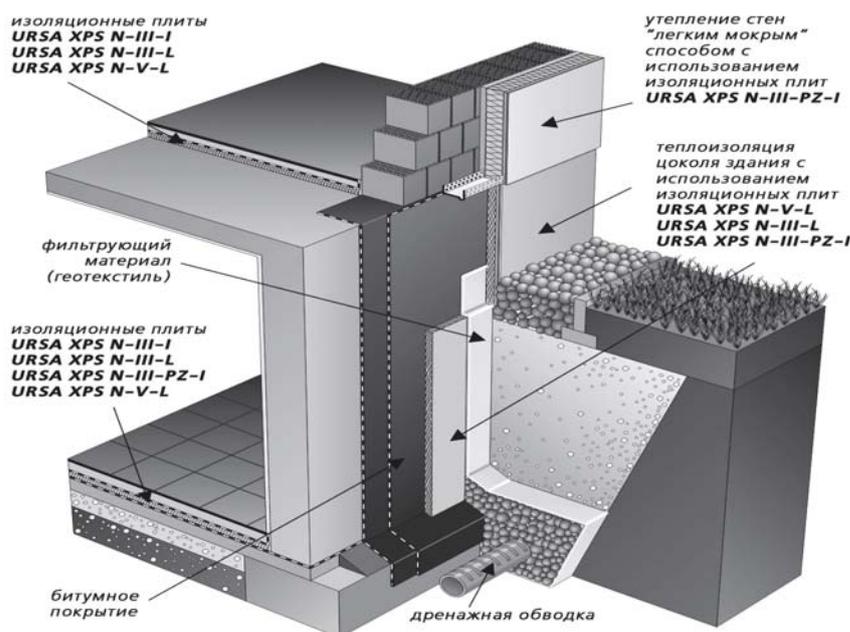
Схемы утепления цокольной и подвальной части здания
